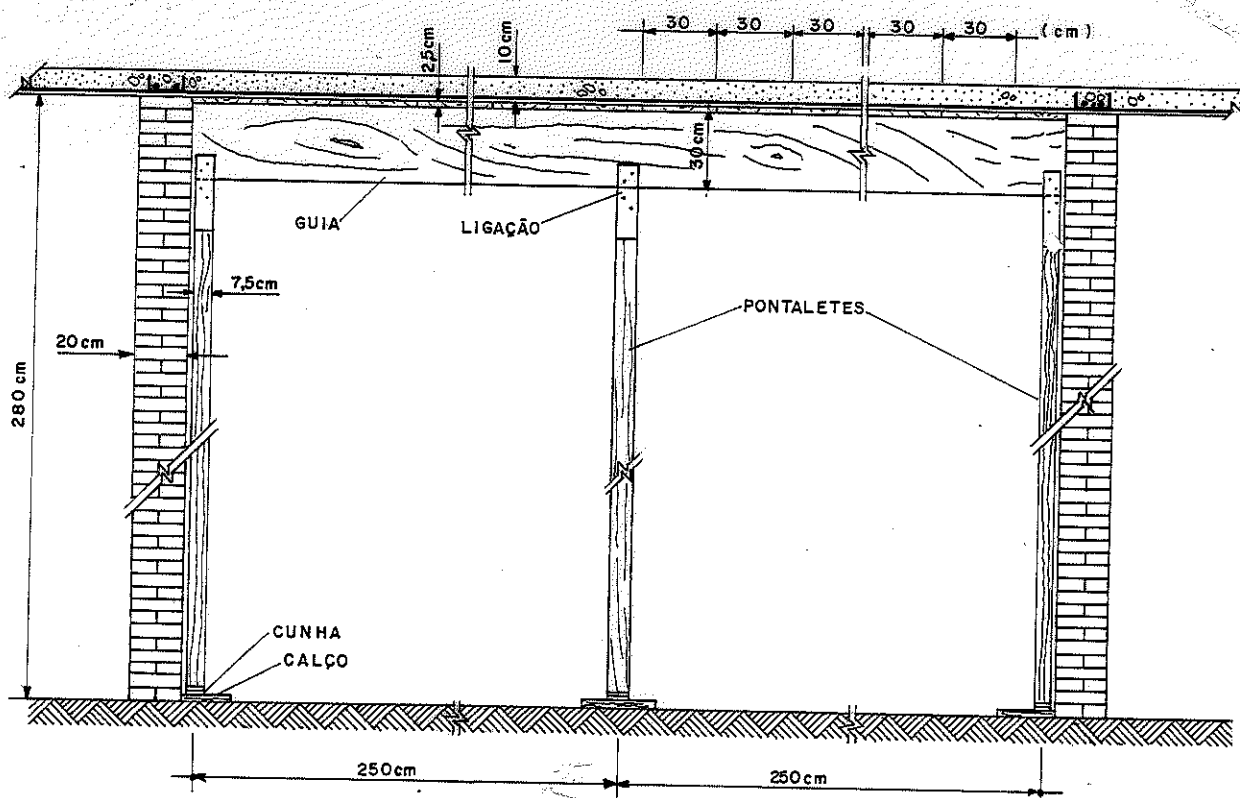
CORTE DA LAJE SOBRE ALVENARIA. DETALHES DA FORMA E DO CIMBRAMENTO DA LAJE
